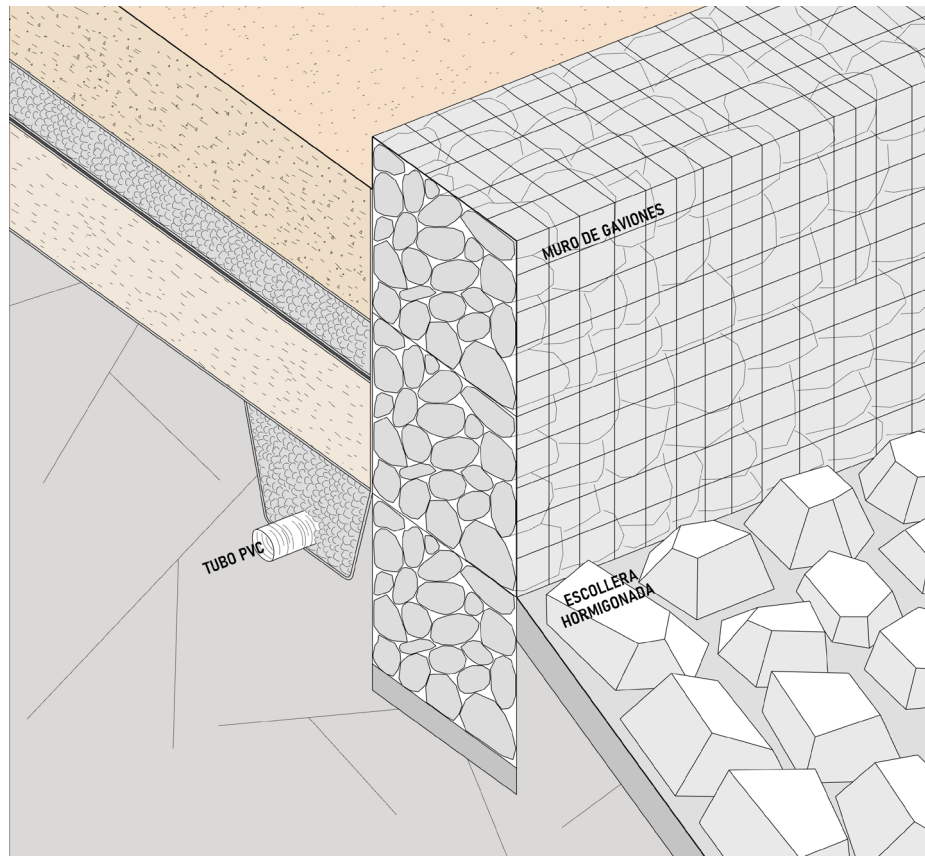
Detalle del tratamiento T1, encuentro con zonas de cauce (gavión y escollera hormigonada) y drenajes internos.
